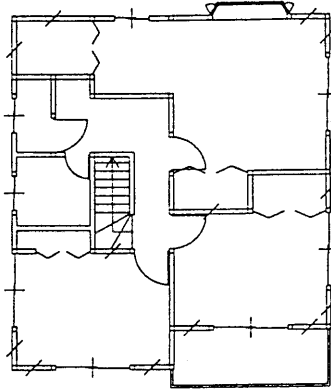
解析対象建築物平面図 (No.23, No.24)
